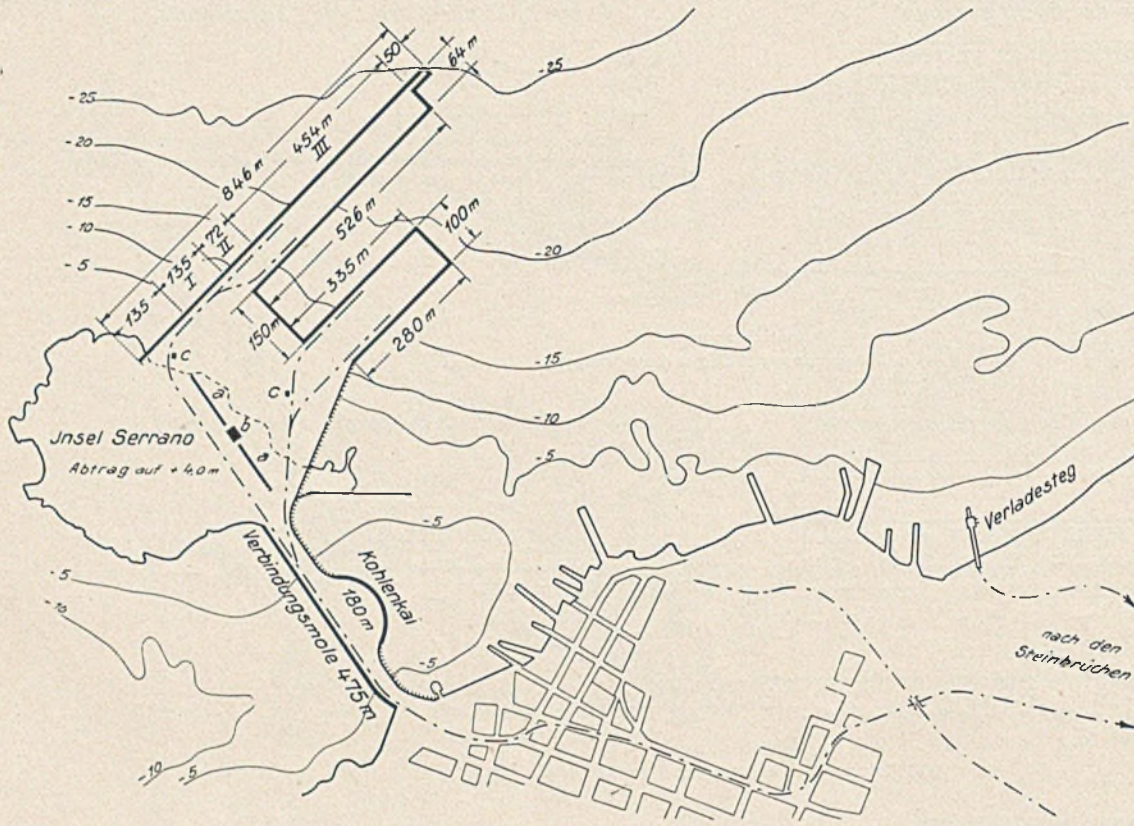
Erweiterung des Hafens Lobito⁶ durch 635 m Kaimauern, 560 000 m³ Baggerung, 3 zweistöckige und 2 einstöckige Lagerschuppen. Die Stahlbetonbrunnen der Kaimauern wurden auf einem wandernden eisernen Arbeitsgerüst in je 2 Teilen über ihrer Absenkstelle hergestellt, abgelassen und durch Aushub mittels Greifer abgesenkt. — Da sich bei Probelastungen eine geringere Tragfähigkeit des Sandes herausstellte als angenommen war, wurden der Untergrund durch Pfahlrammung unter dem Brunnen verdichtet und die vor der Probelastung fertiggestellten Pfeiler verankert.
